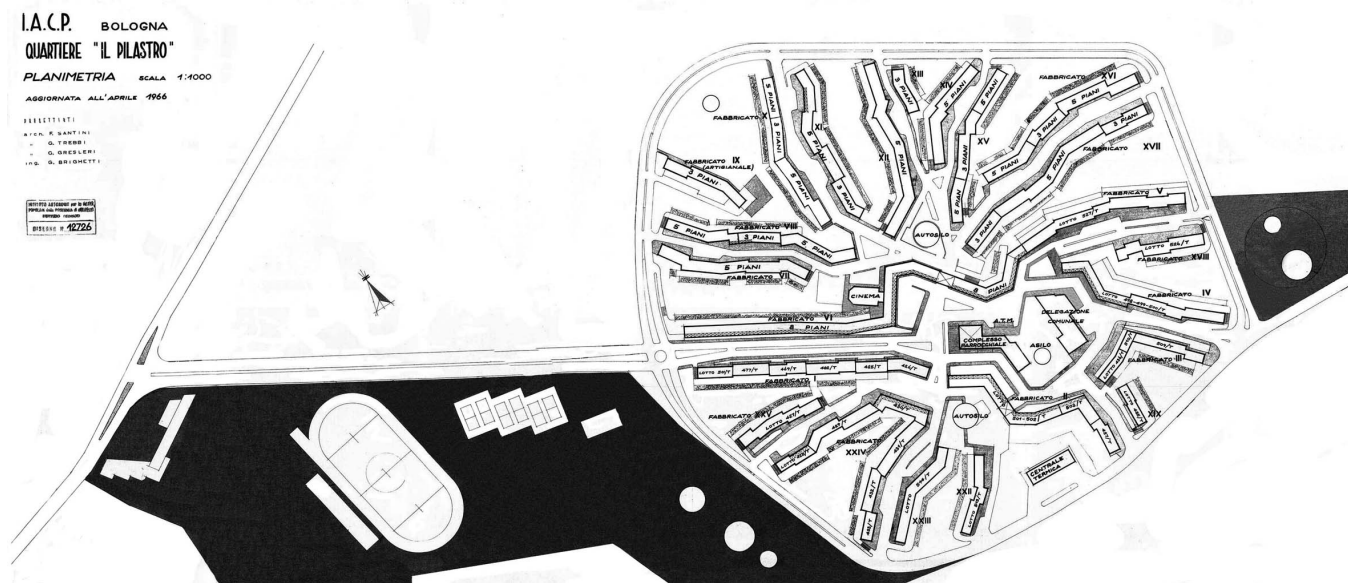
Quartiere "Il Pilastro", versione definitiva. Planimetria, 1966. Archivio privato di Glauco Gresleri.
